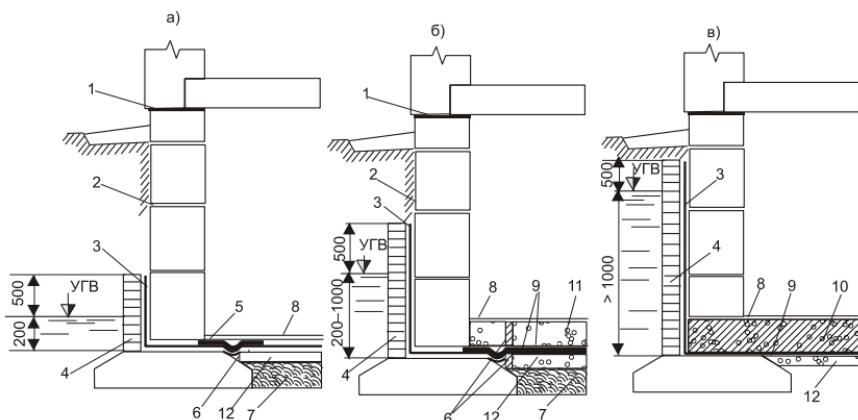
Гидроизоляция фундаментов : а) при напоре грунтовых вод менее 200 мм; б) при напоре 200—1000 мм; в) при напоре свыше 1000 мм;
